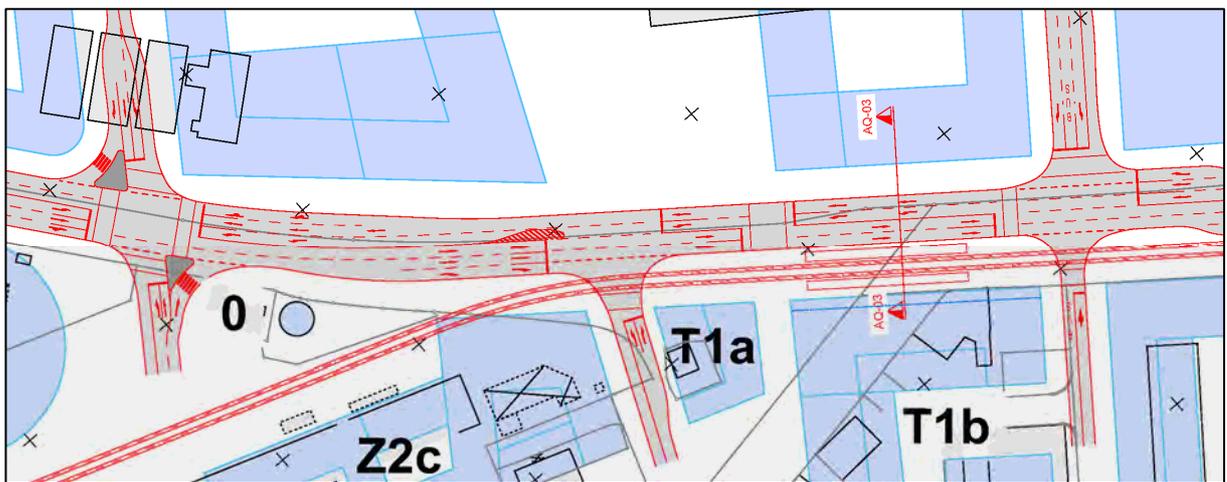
Lageplan Czernyring Bereich Mitte, Variante 2+1
